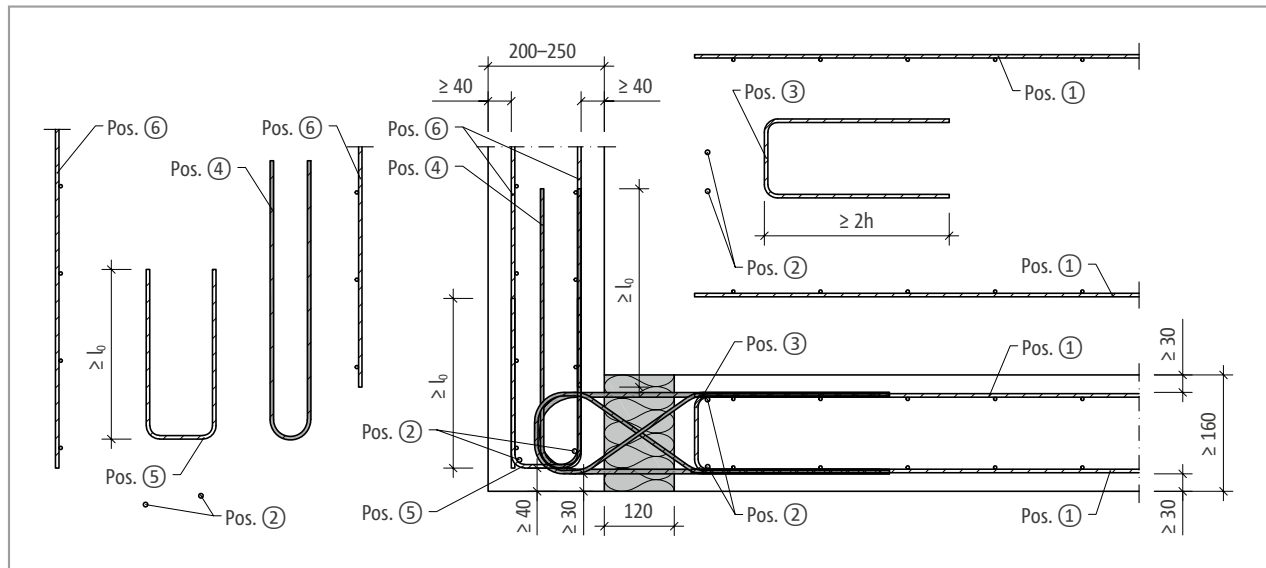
Schöck Isokorb® XT Typ F: Bauseitige Bewehrung bei Brüstungsbreite  $b = 200-250$ ; Bauseitige Bewehrung  $b = 160-190$  wie  $b = 200-250$  ohne Pos. 5
